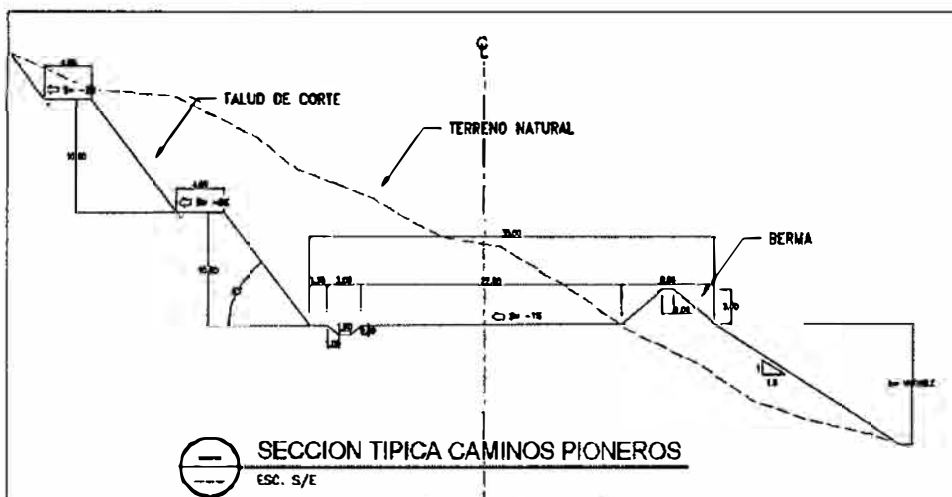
Sección transversal de caminos pioneros en corte y relleno.
